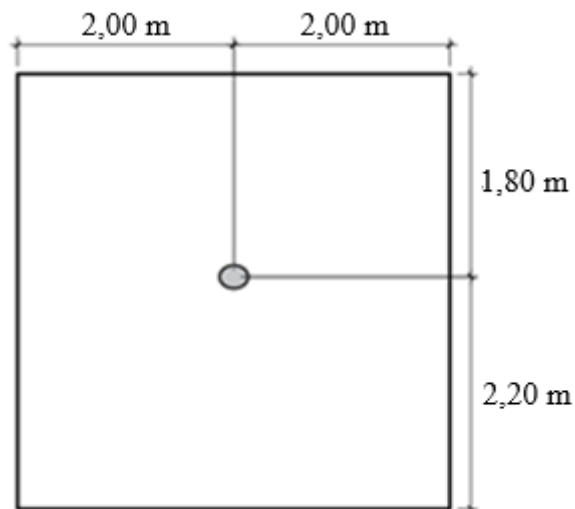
Laje lisa com pilar central de seção elíptica.
